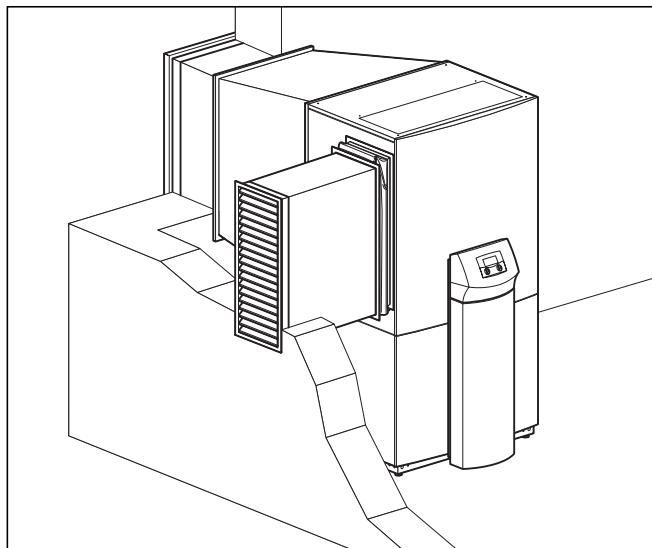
Conduit d'arrivée d'air conique, conduit de sortie rigide
